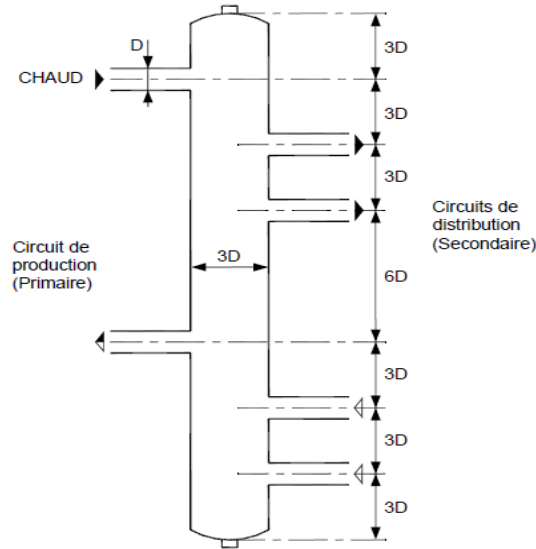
Bouteille de découplage dimensionnée selon la règle des « 3D »
